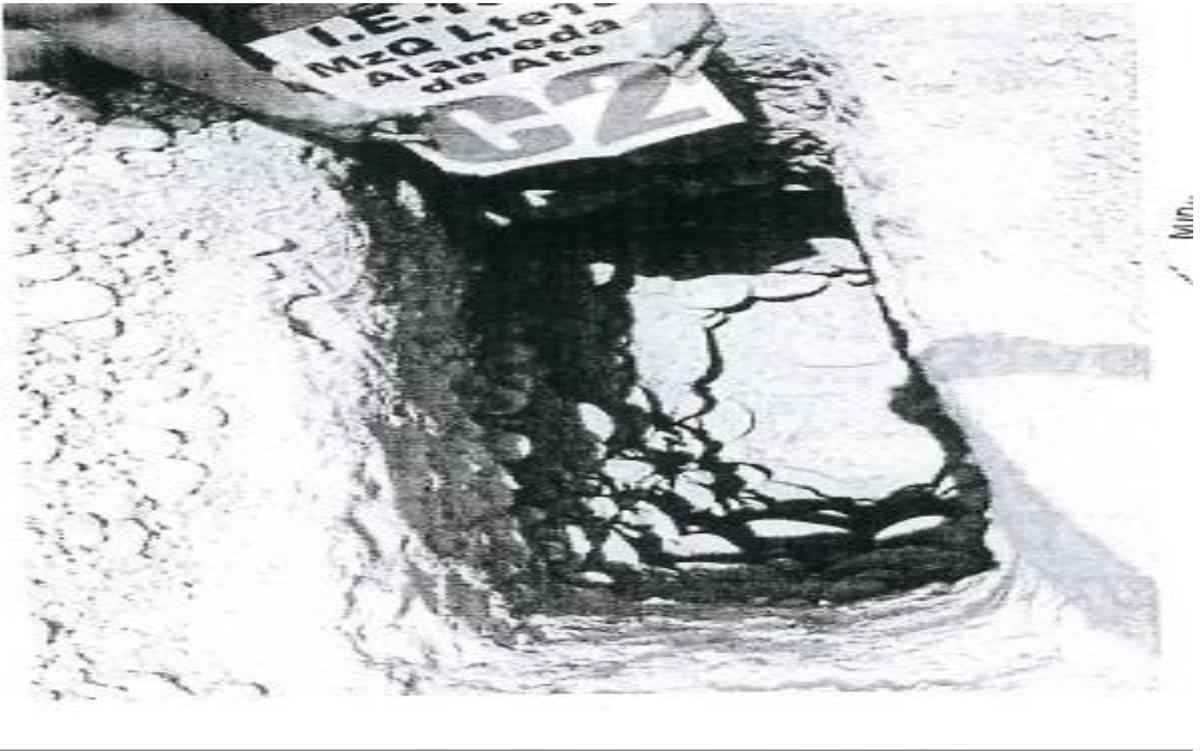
Calicata C – 02, IEI N° 153 – Santa Anita
